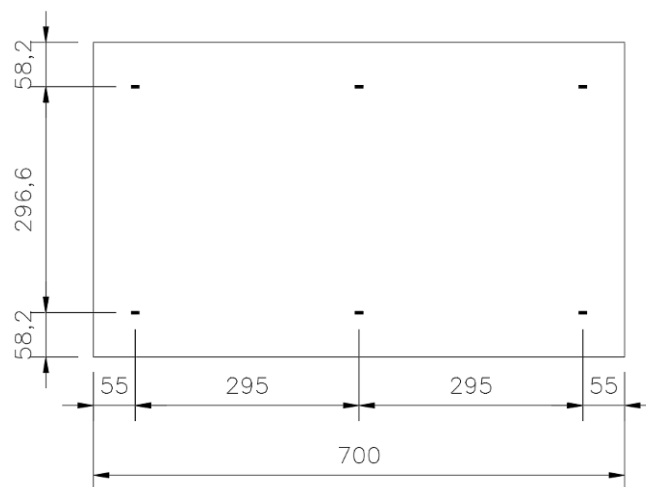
Projeto estrutural: Planta do Pav. Térreo. Dimensões: milímetros.
